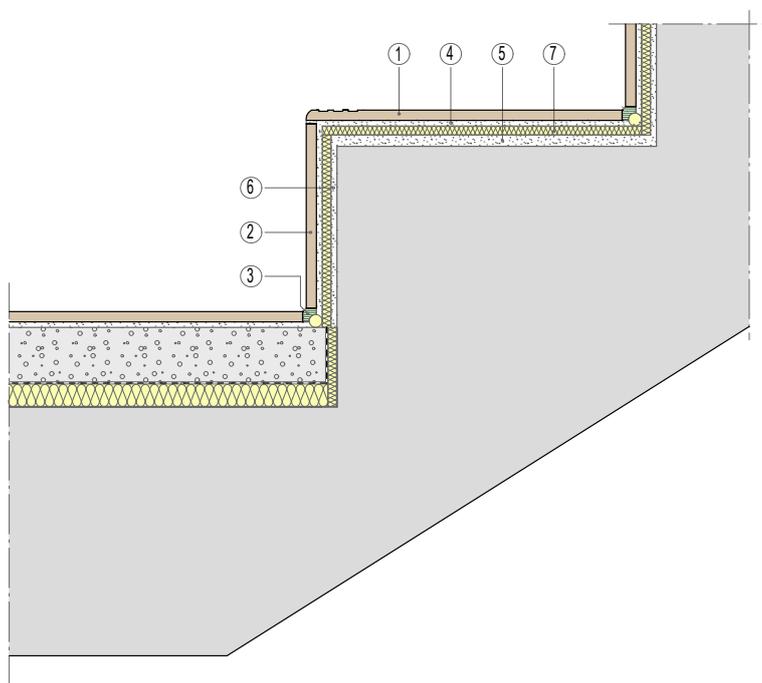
Escalier en béton coulé en place avec marches acoustiquement isolées
